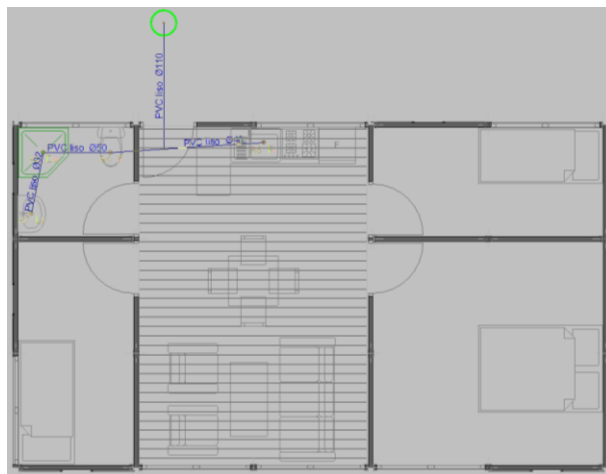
Conexión de saneamiento de la vivienda de 1 planta, vista 2D
